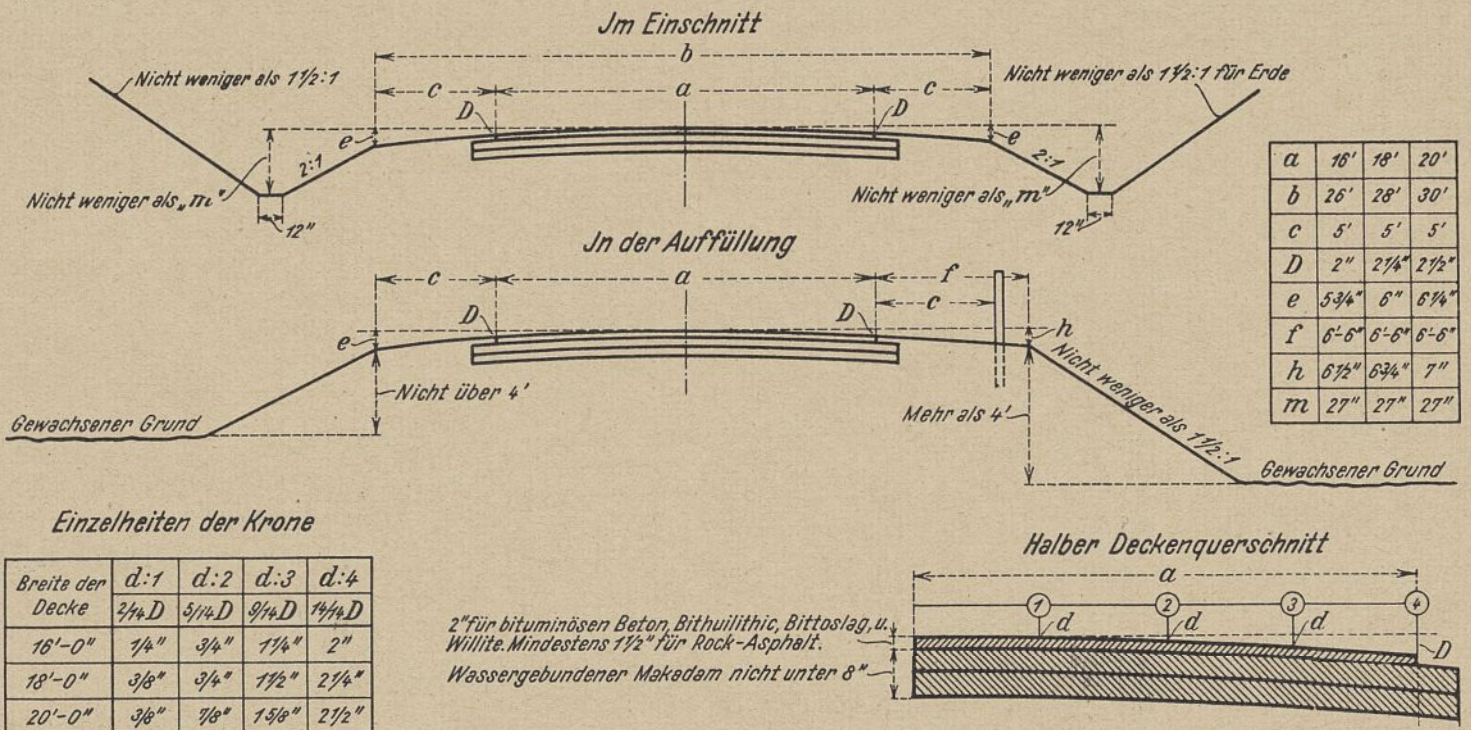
Standardplan für bituminösen Beton. Ohio 1923 Zu II.
